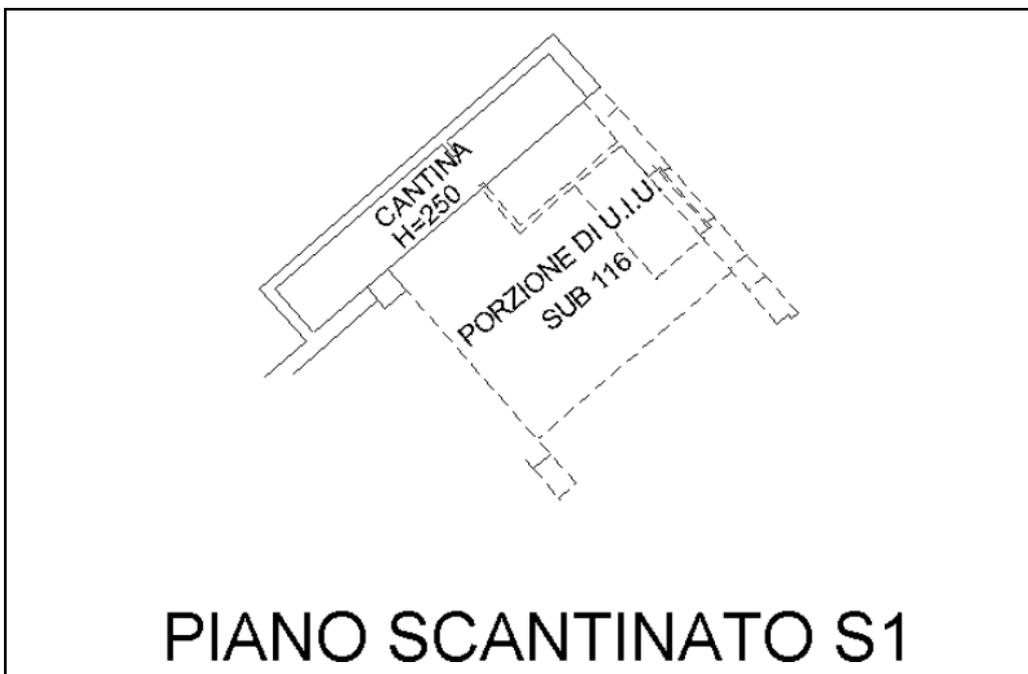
planimetria catastale della cantina sub 117 posta al piano interrato
